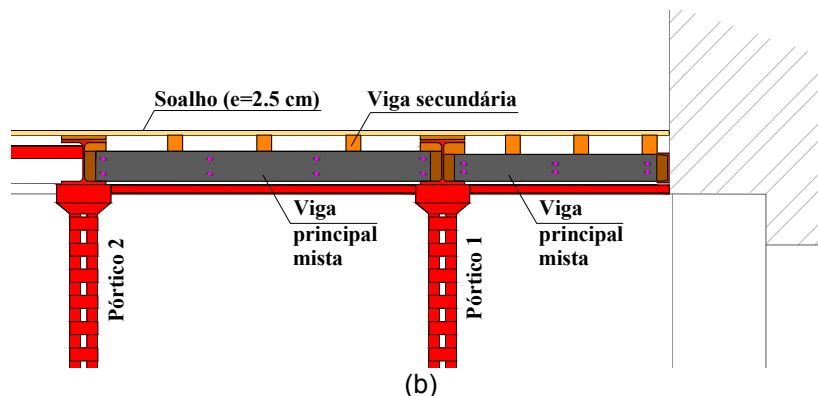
Corte transversal do reforço do vigamento do pavimento do coro alto em zona de colocação do órgão.
